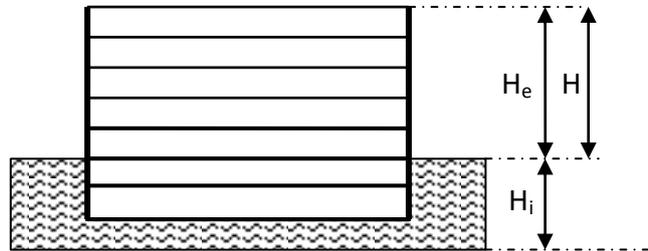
Hauteur de calcul dans le cas d'un sol monocouche résistant
